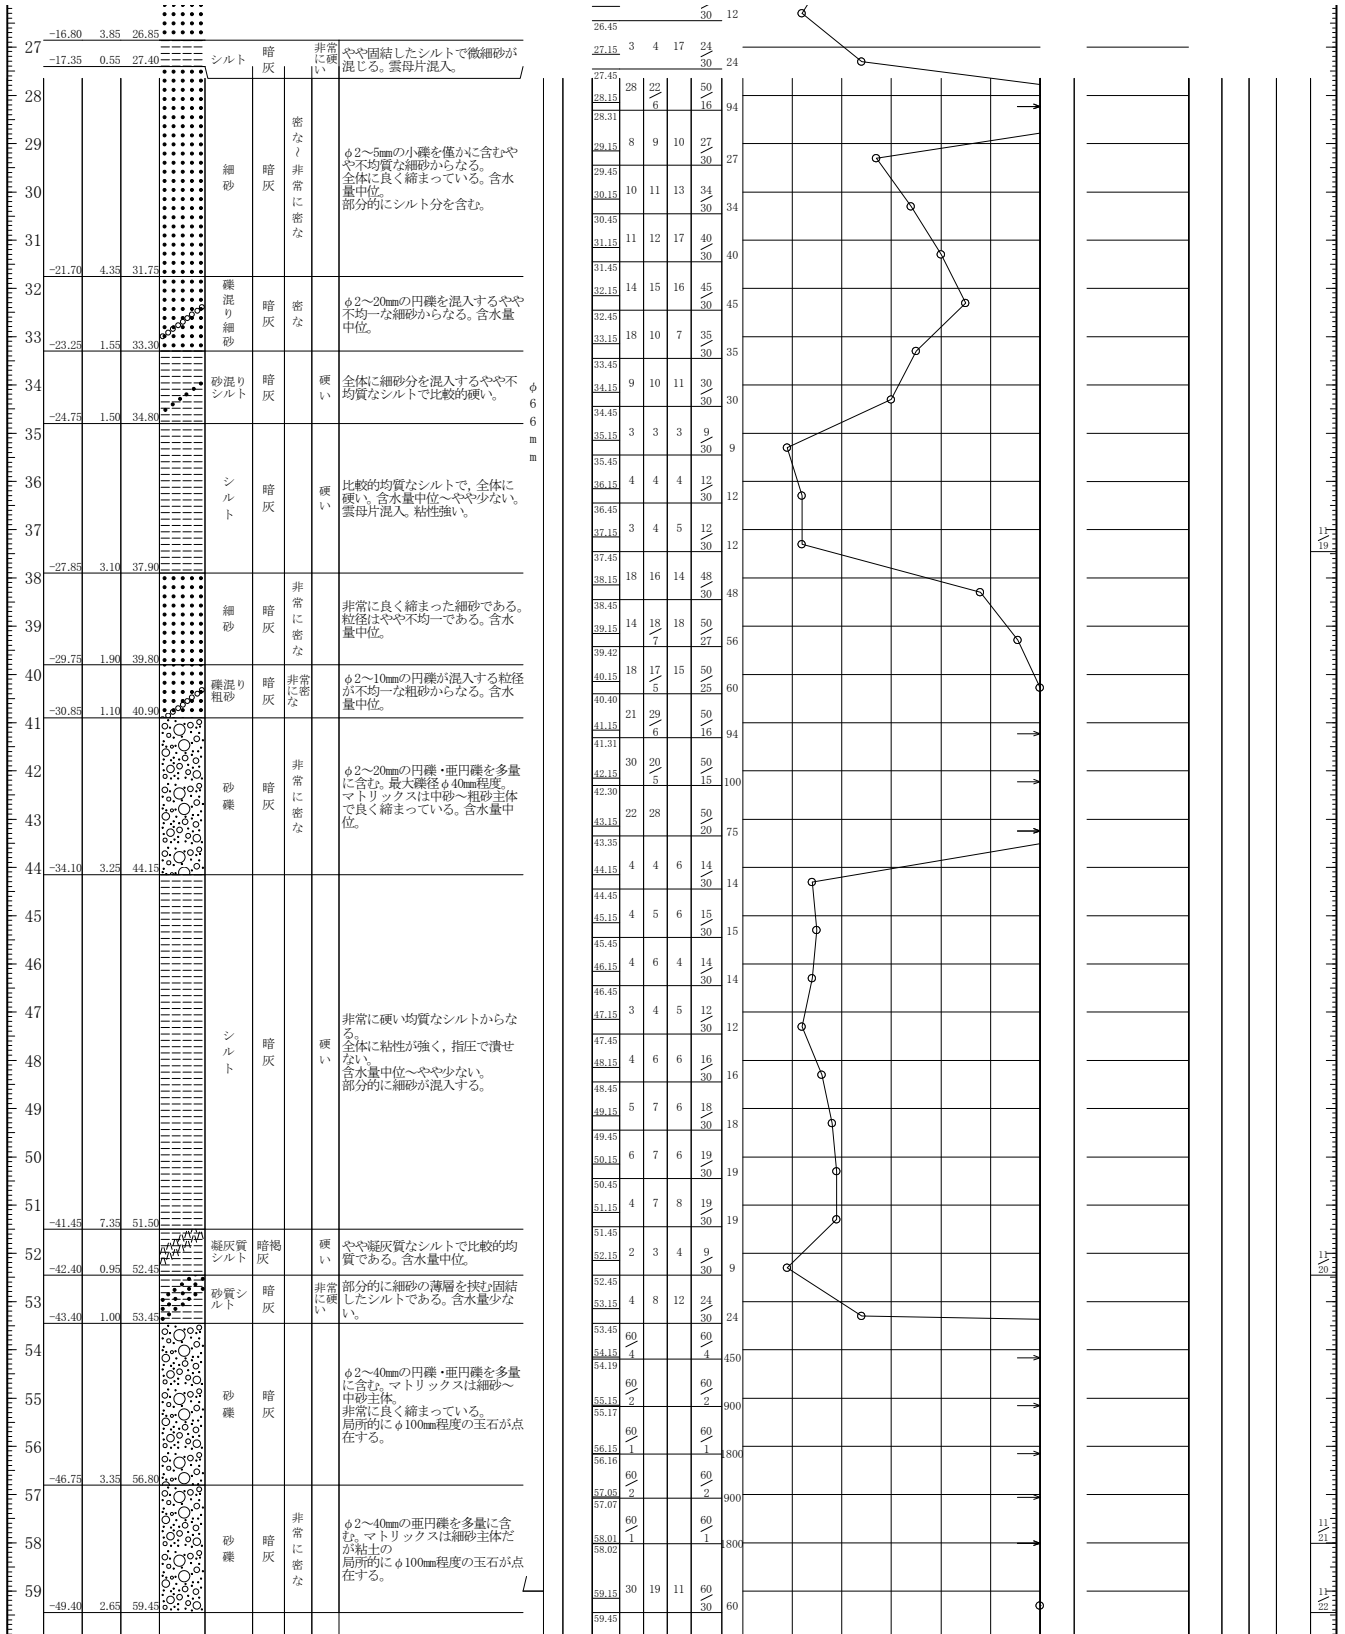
(1) ボーリング柱状図 (No.3-1)
